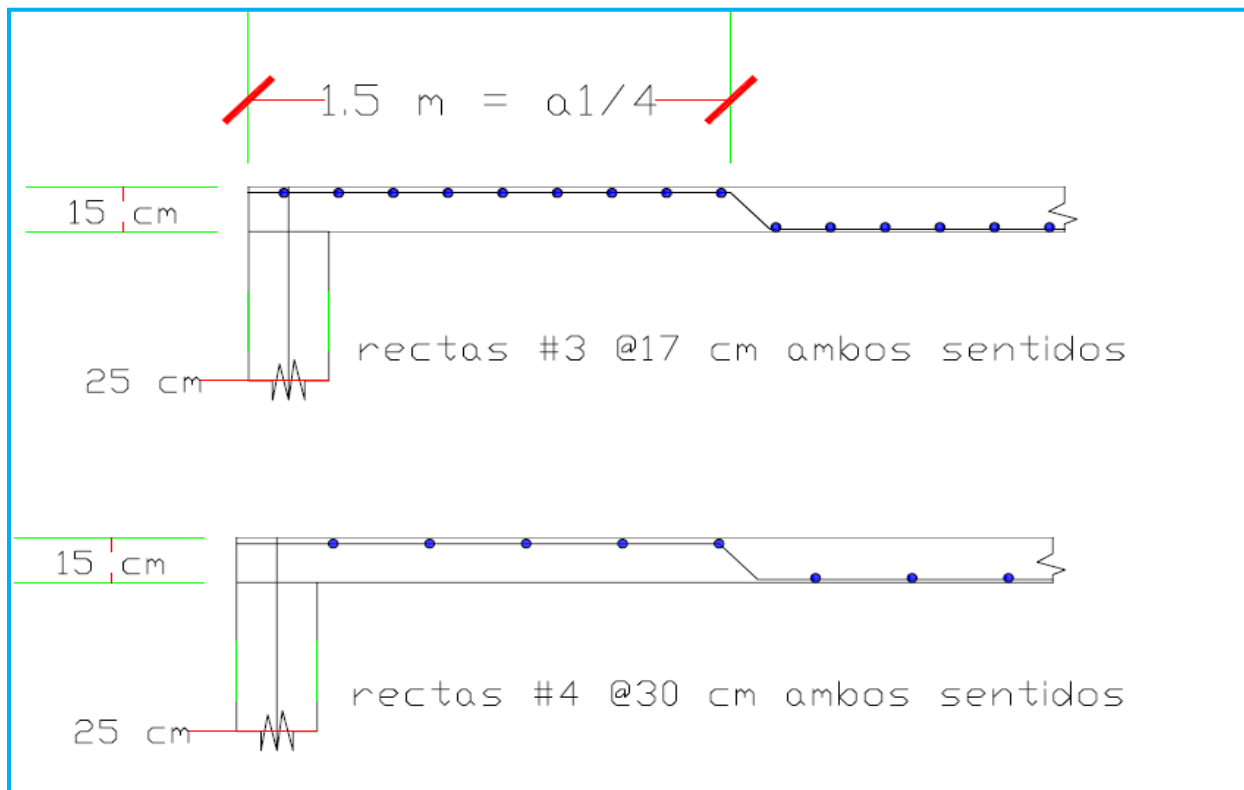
Croquis de los armados de la losa con acero mínimo para varillas del # 3 y # 4, para el lado cortó
